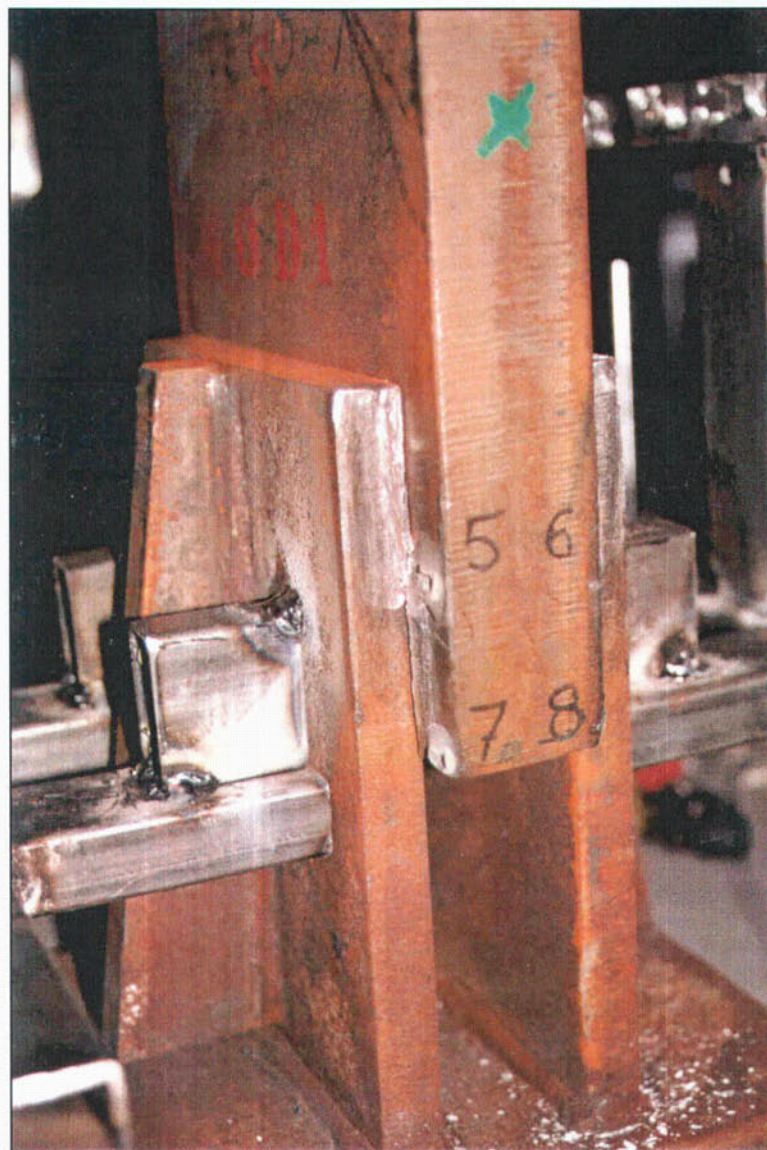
Detalle de la probeta 1S ya rota, con las soldaduras limpias de cal. Se observa en la fotografía la rotura de las soldaduras 5-7 y 6-8 por la sección de garganta.
